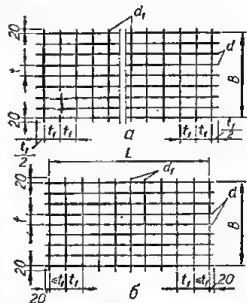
Сварные сетки заводского изготовления:
